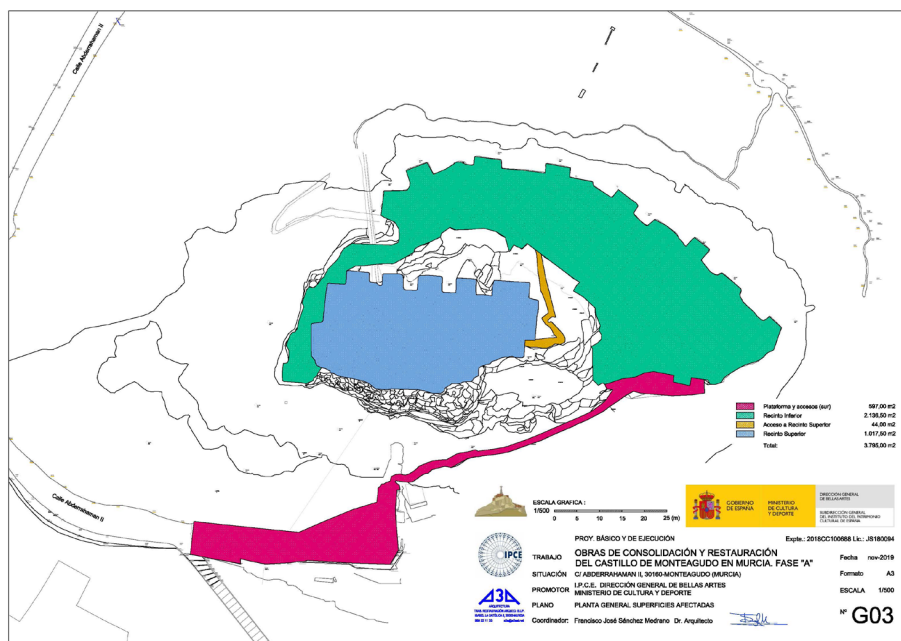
Plano del área intervenido durante la “Fase A” del proyecto. Fuente: Proyecto Fase A.
